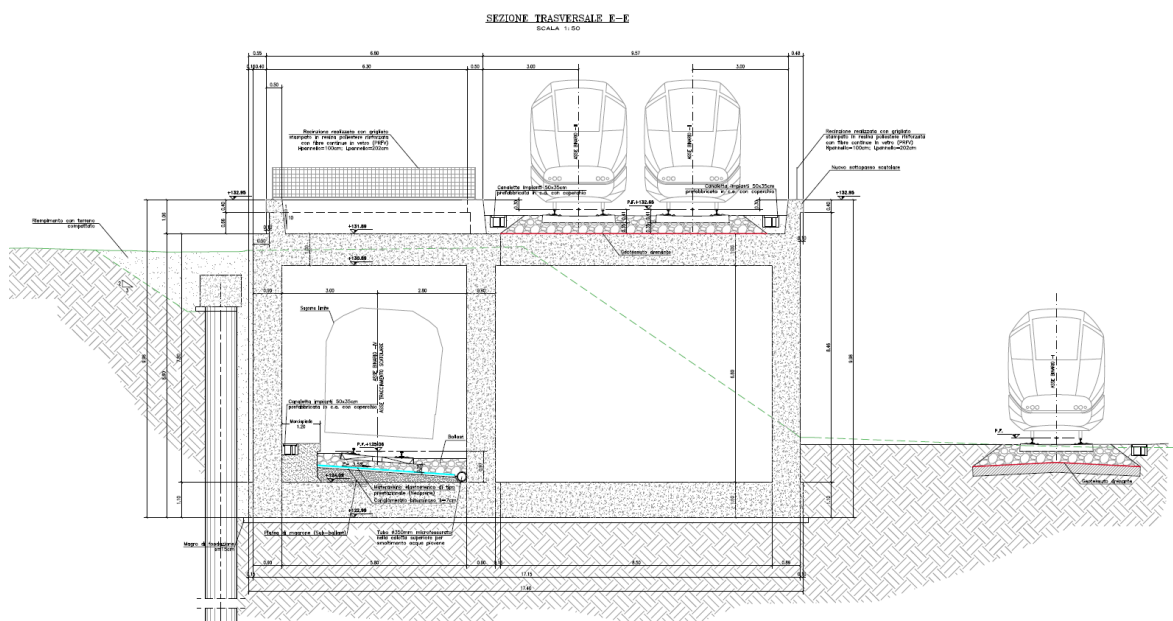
Sezione trasversale manufatto scatolare in asse al binario –IV e sezione sviluppo est con scavalco binari –II e –III.
